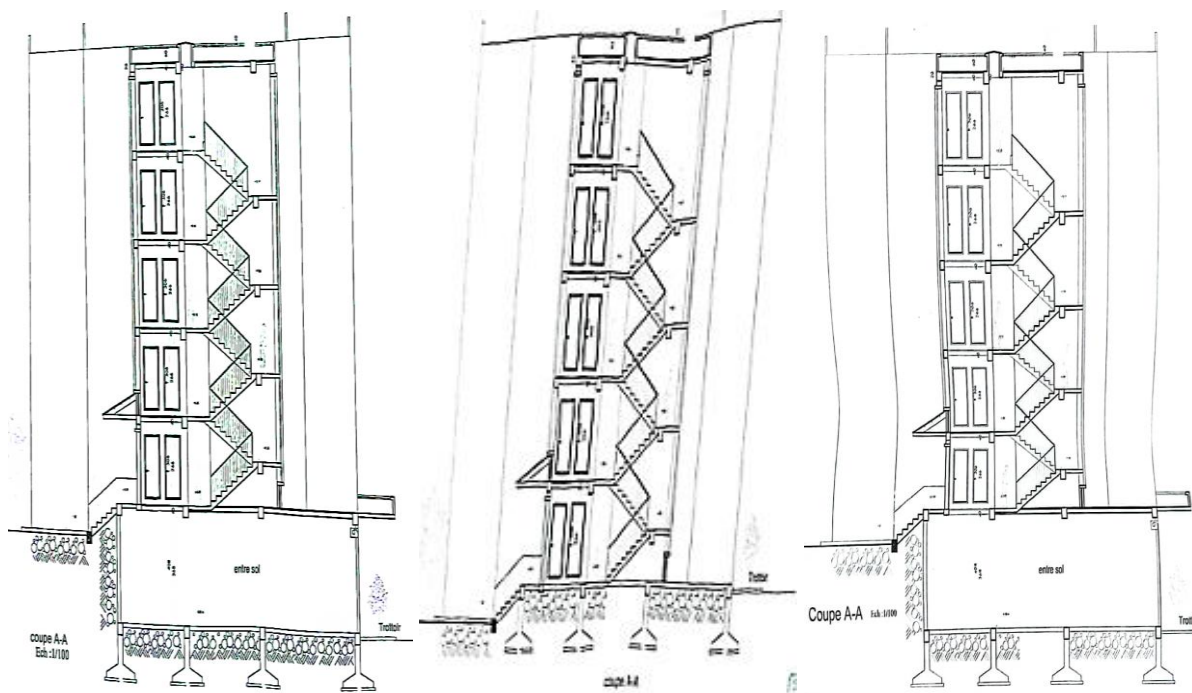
Plan de coupe des blocs A, B, C, D, E & F
